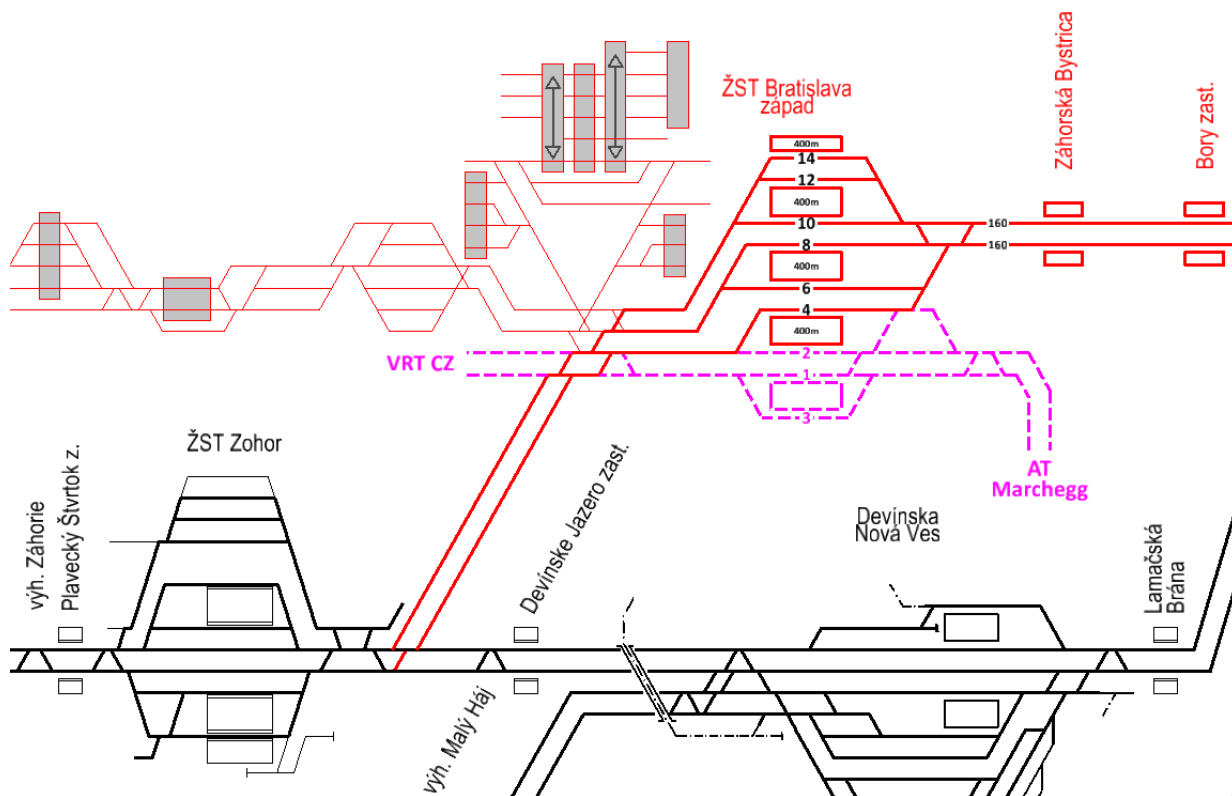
Úprava IM 04 ŽST Bratislava západ
